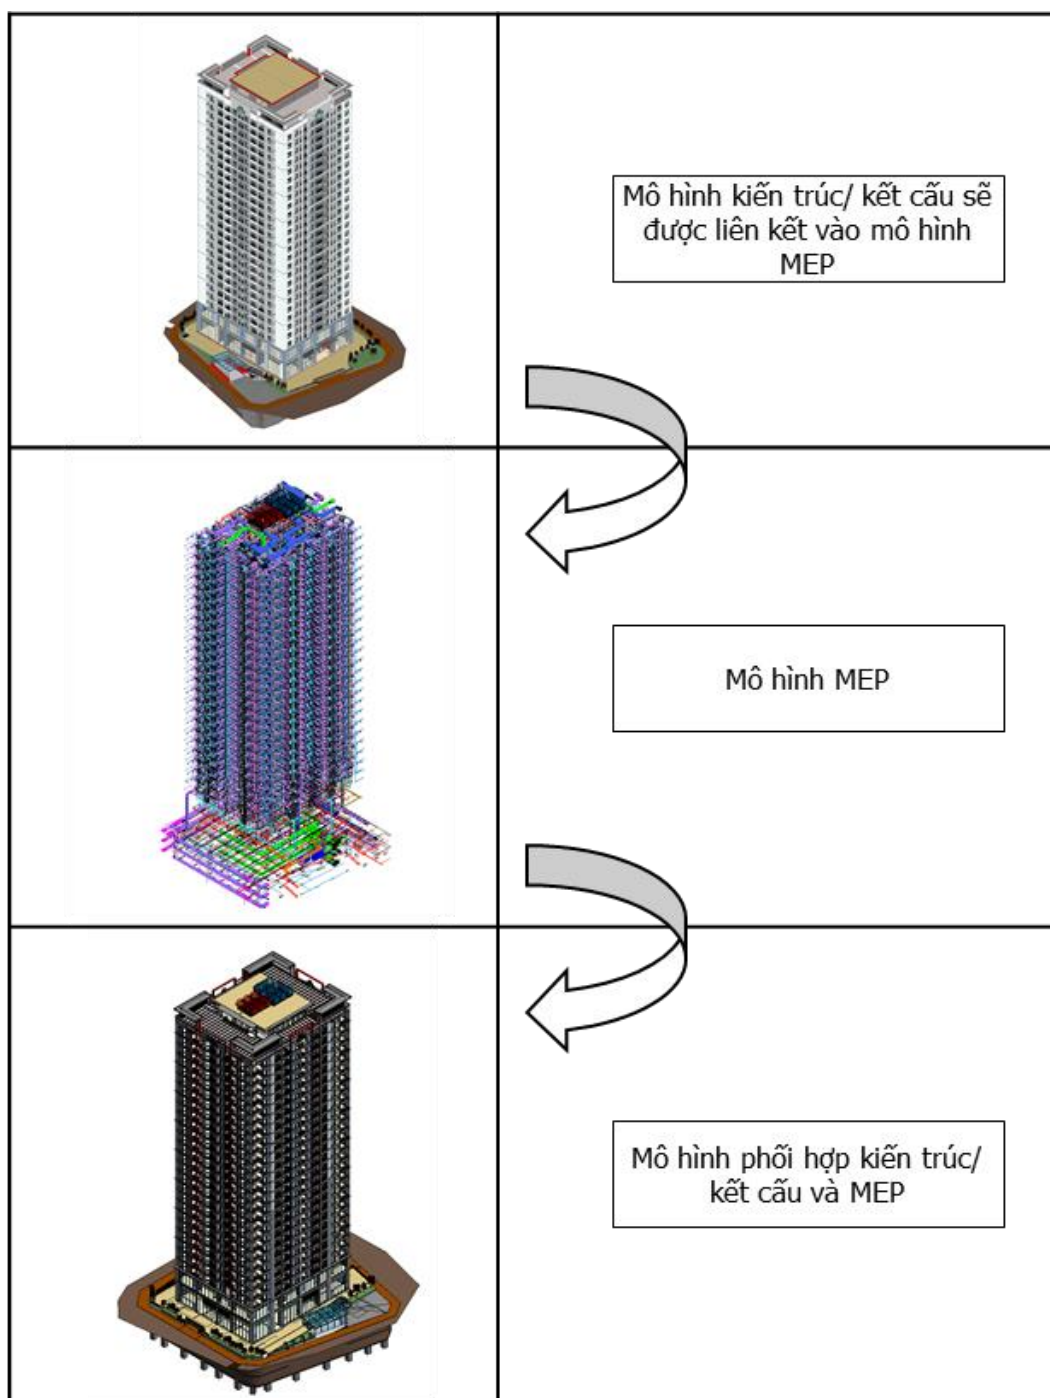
Phối hợp mô hình giữa kiến trúc và kết cấu
